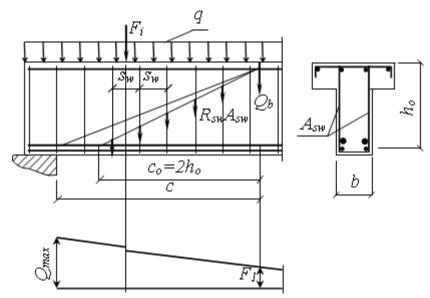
Схема усилий в наклонном сечении элемента, армированного хомутами, при расчете на действие поперечной силы
